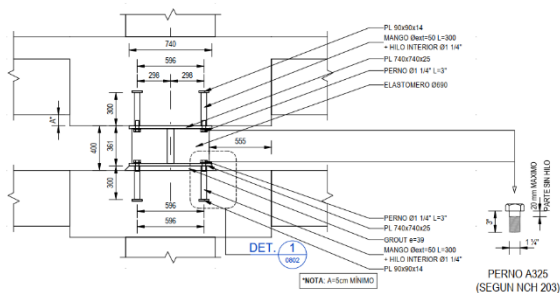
Detalle general de aislador con núcleo de plomo AS1.
